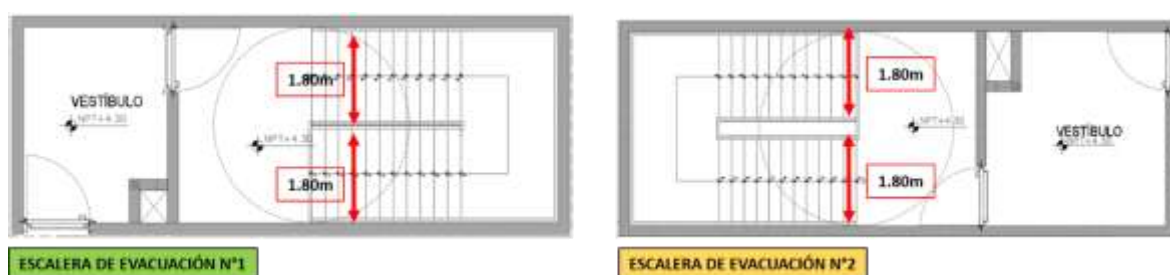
Ancho considerado en escalera de evacuación N°1 y N°2
